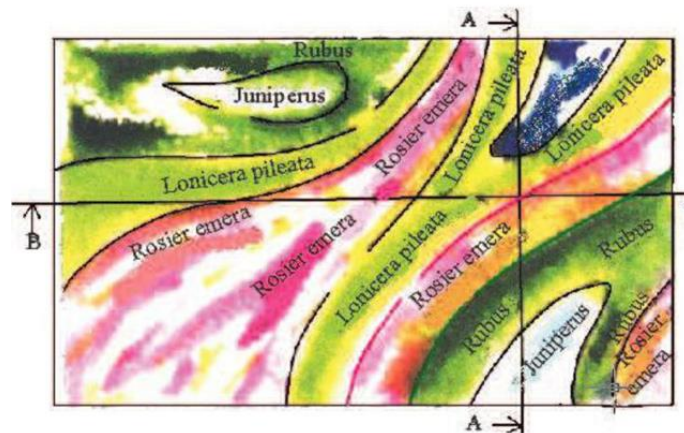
Exemple de plan de plantation d'une toiture végétalisée semi- intensive
